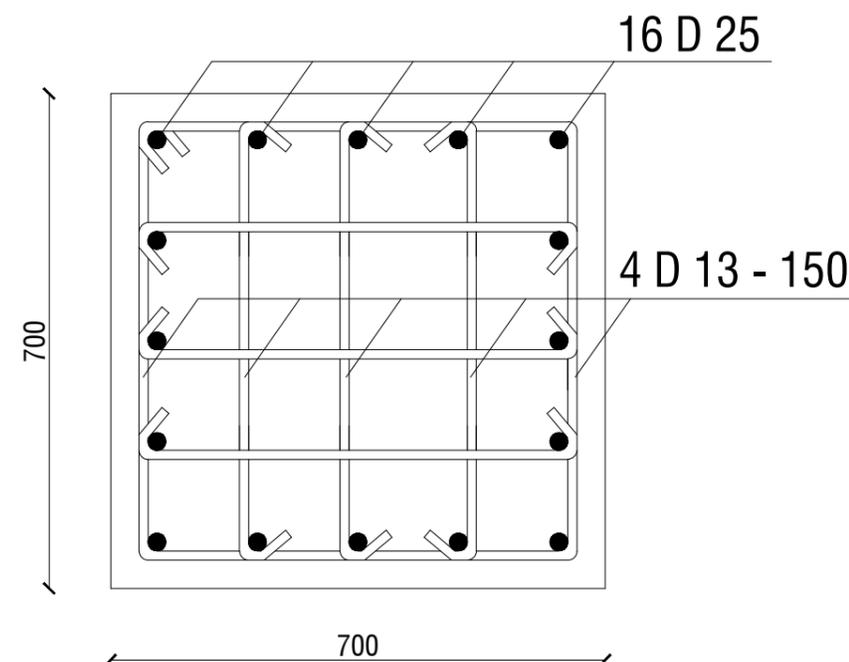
DETAIL PENULANGAN KOLOM K1-1 (L = 4,04 m)
